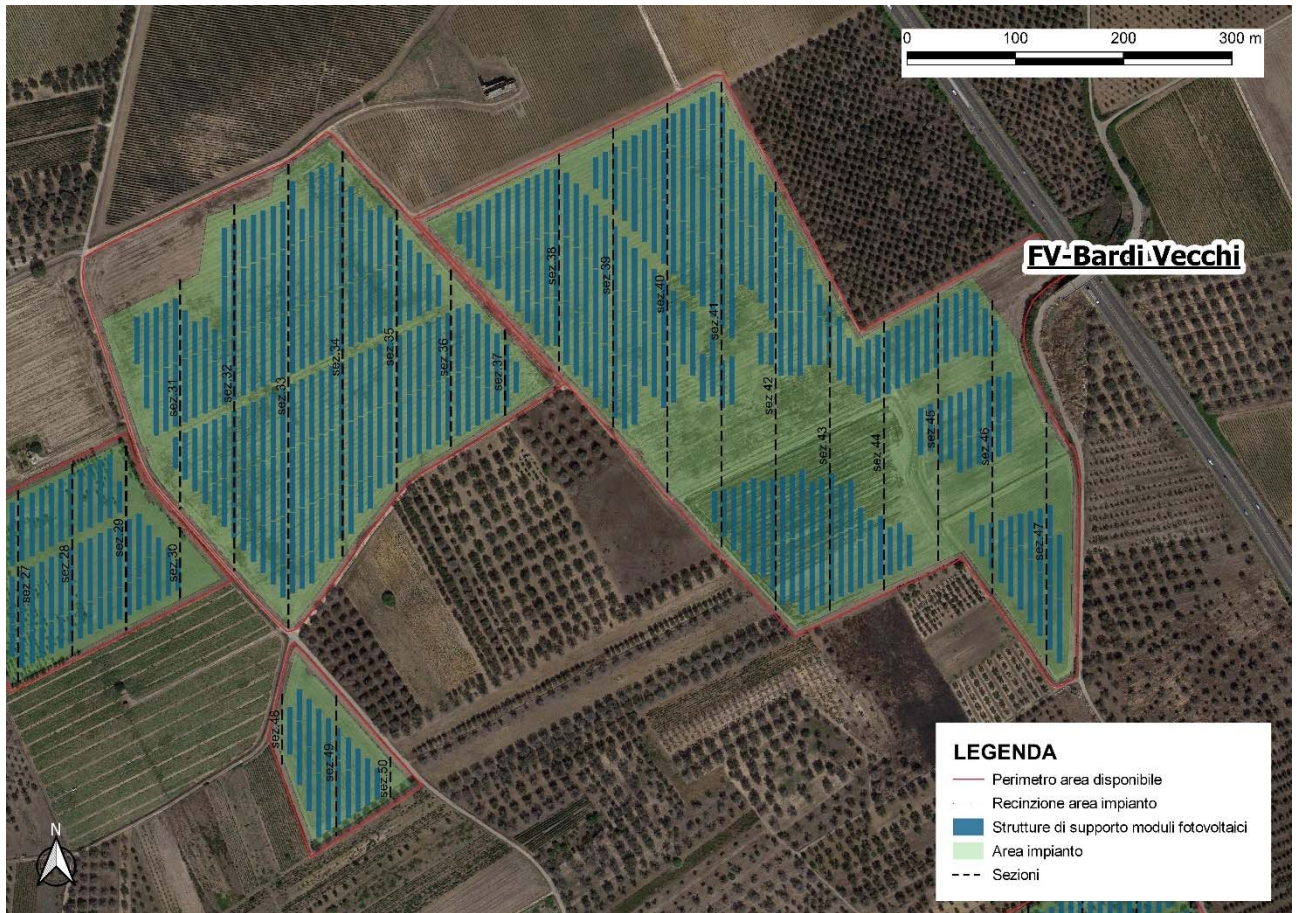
Sezioni sul sito di installazione FV-Bardi Vecchi
